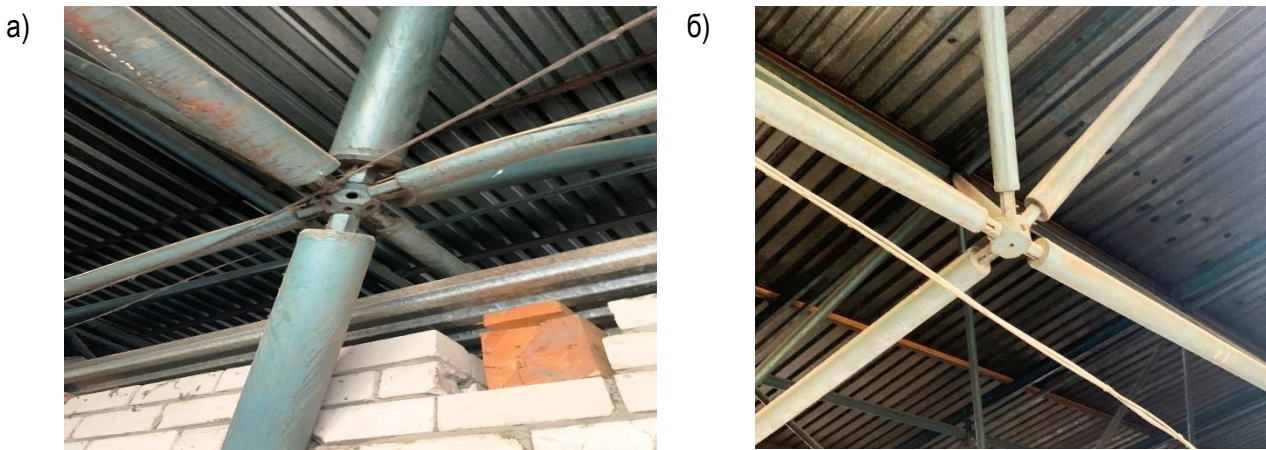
Типовые узлы сопряжения стержней нижних поясов: а) в месте примыкания к капители (в узле использован сферический элемент), б) в пролете (в узле использован полусферический элемент)
